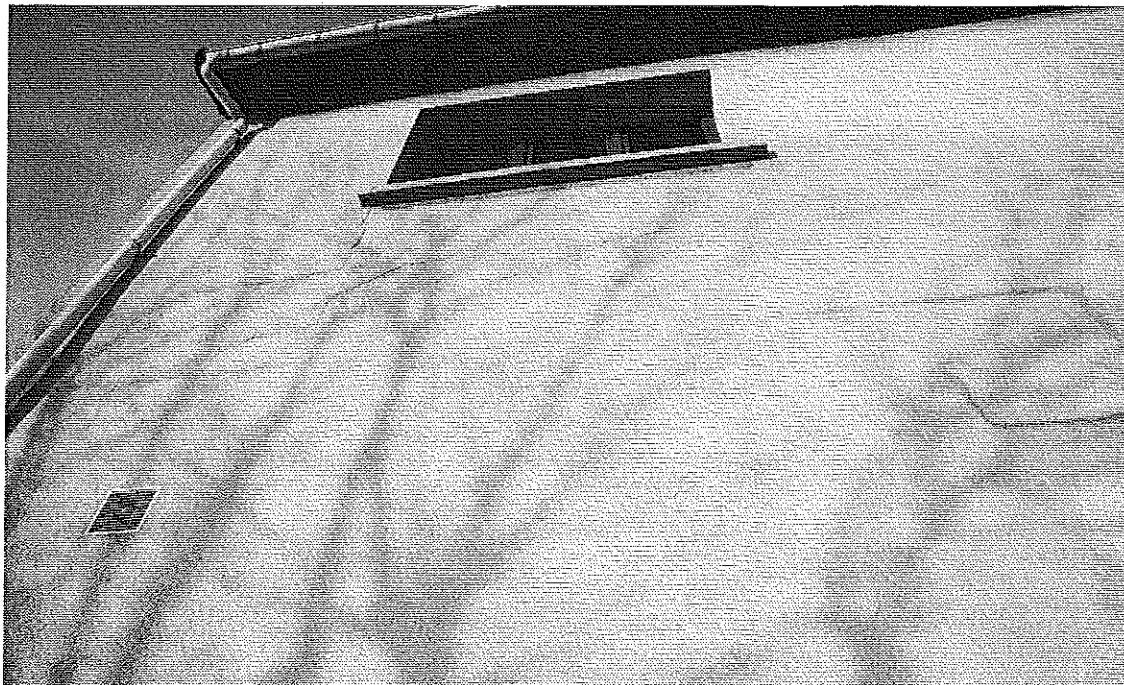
Façade arrière. Présence de fissures horizontales et verticales. Noter la descente EP dans l'angle.
